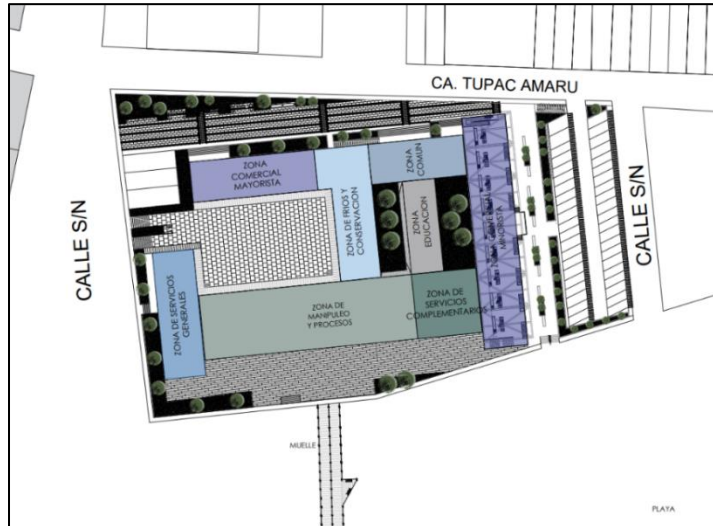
Plan Maestro del Proyecto. Fuente: Elaboración Propia
